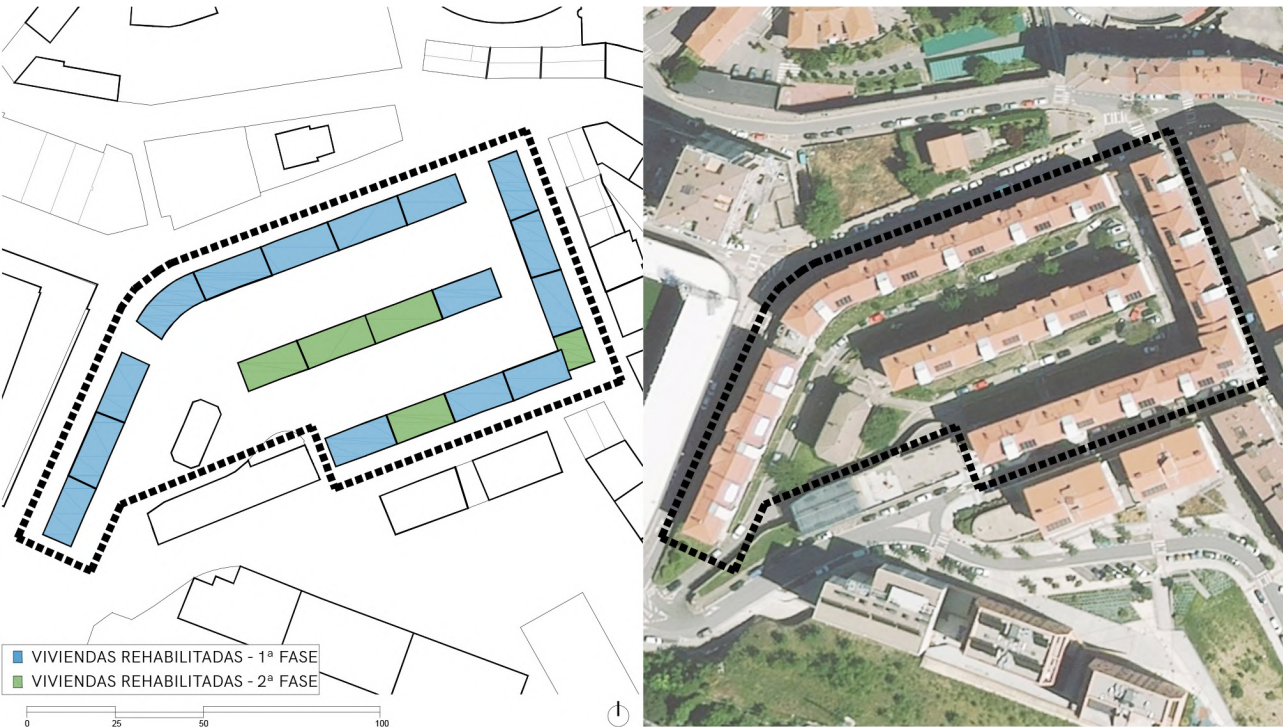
Delimitación del ámbito: Plano de situación y ortofoto
